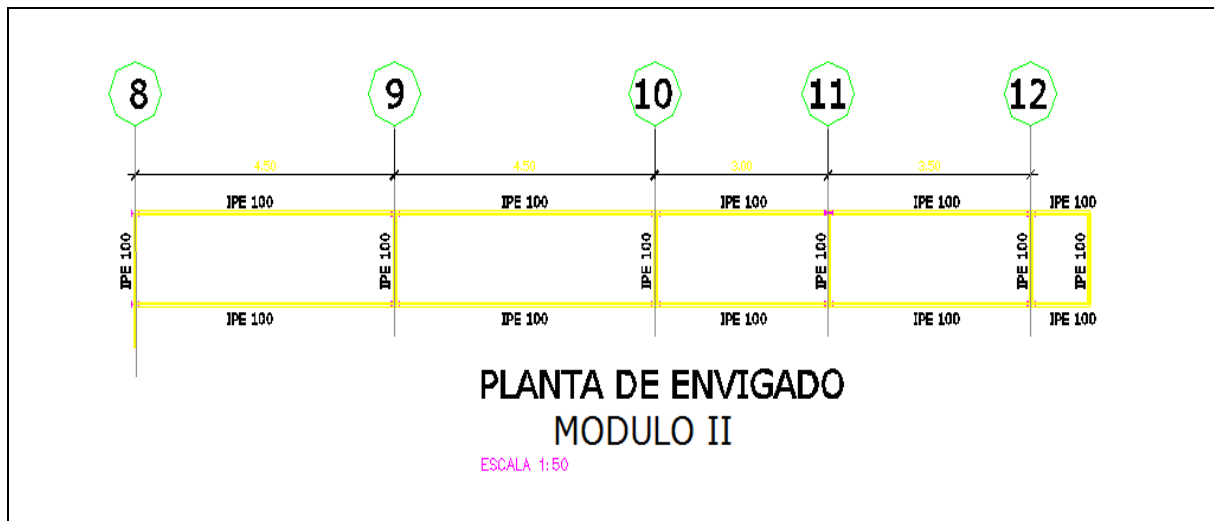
Planta de envigado del modulo II. Fuente: Propia.
